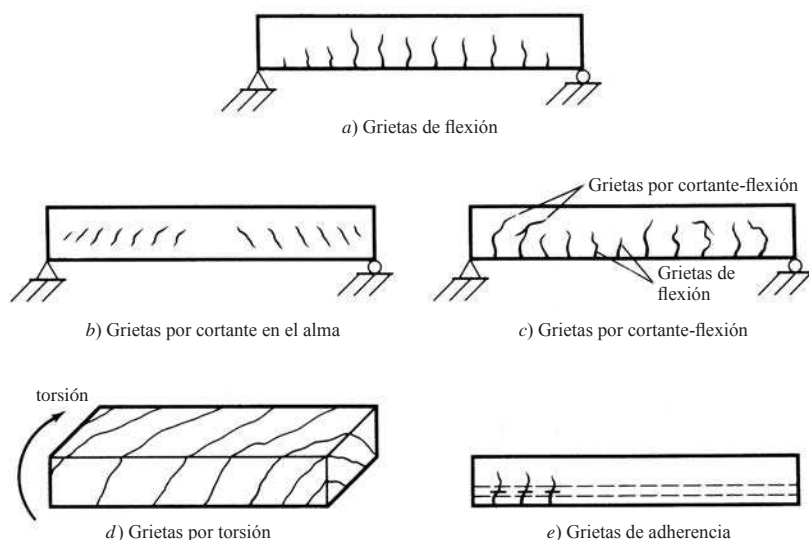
Algunos tipos de grietas en miembros de concreto.
